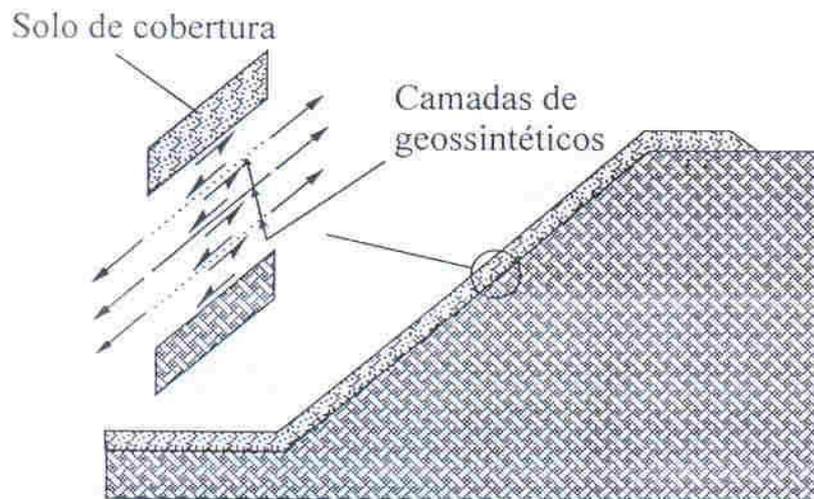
Sistema de cobertura multicamadas (Melo *et al.* 2003).
